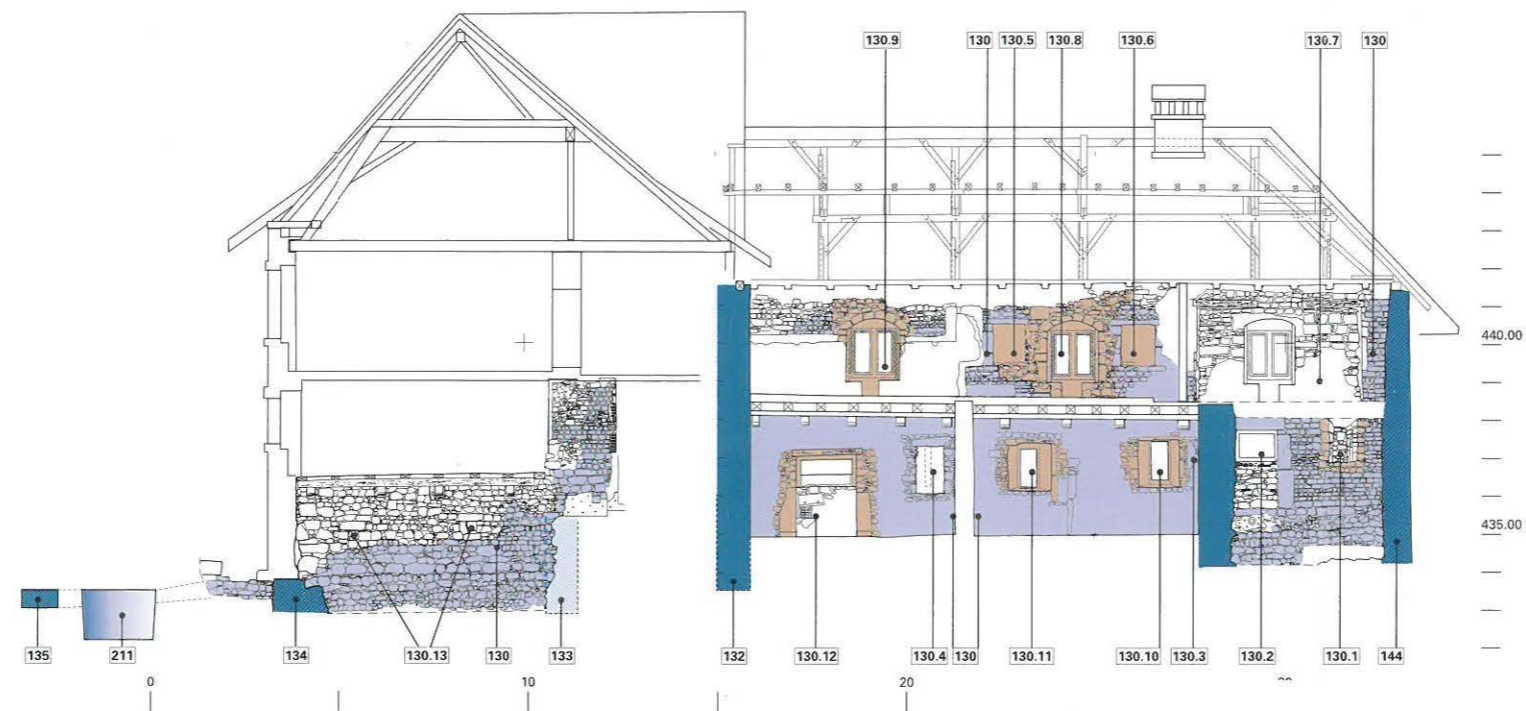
Steingerechter Befundplan Westflügel, Längsschnitt nach Westen. M 1:200.
